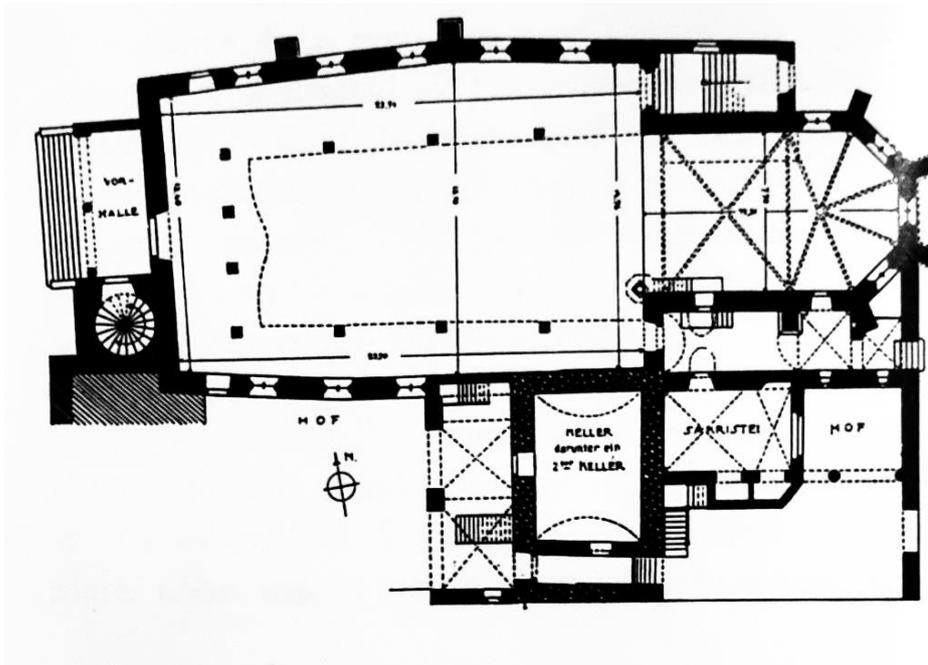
Grundriss der St. Oswaldkirche
